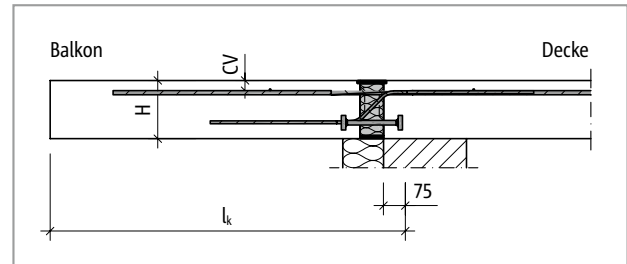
Schöck Isokorb® T Typ K-M12: Statisches System
